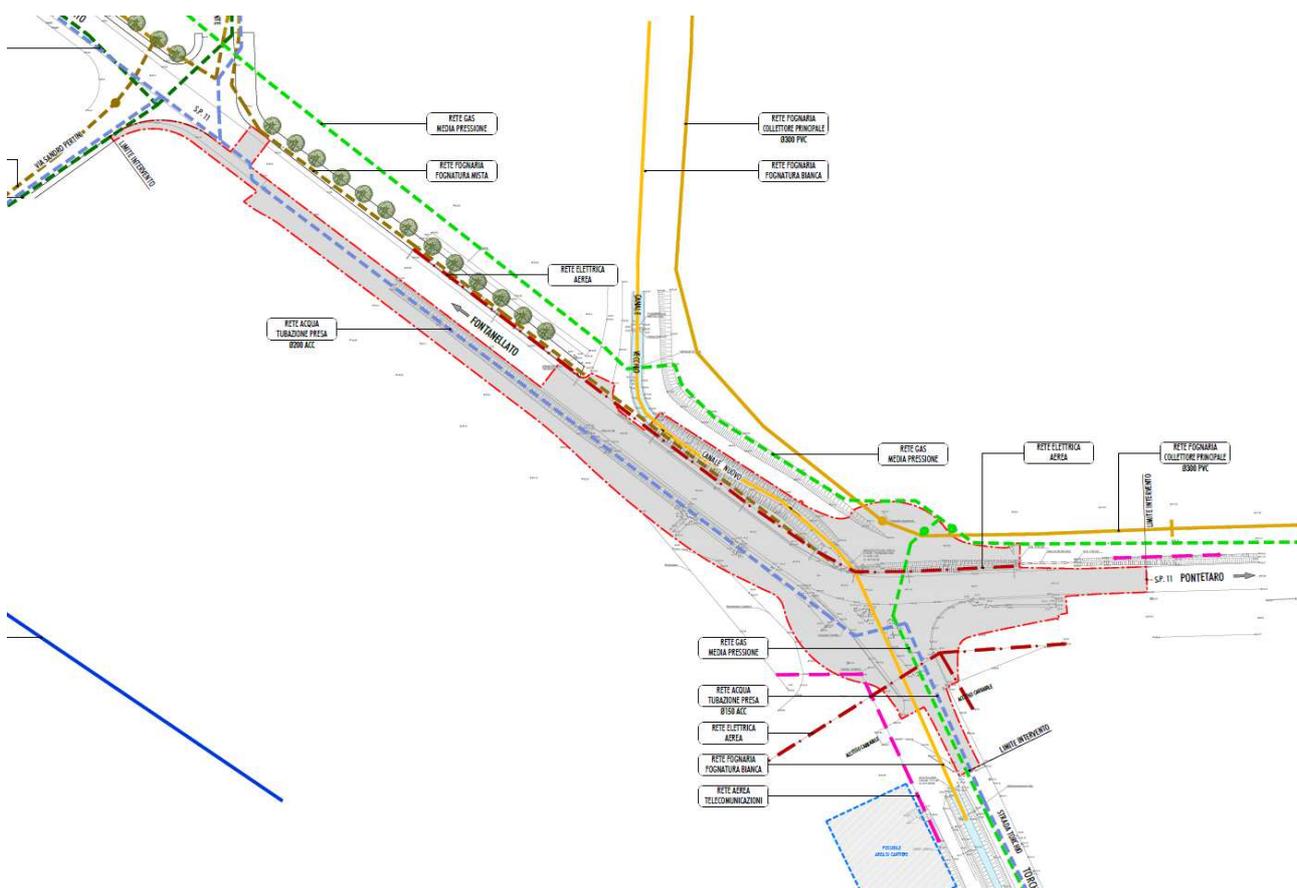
PLANIMETRIA DI STATO DI FATTO CON INDICAZIONE DELLE INTERFERENZE
